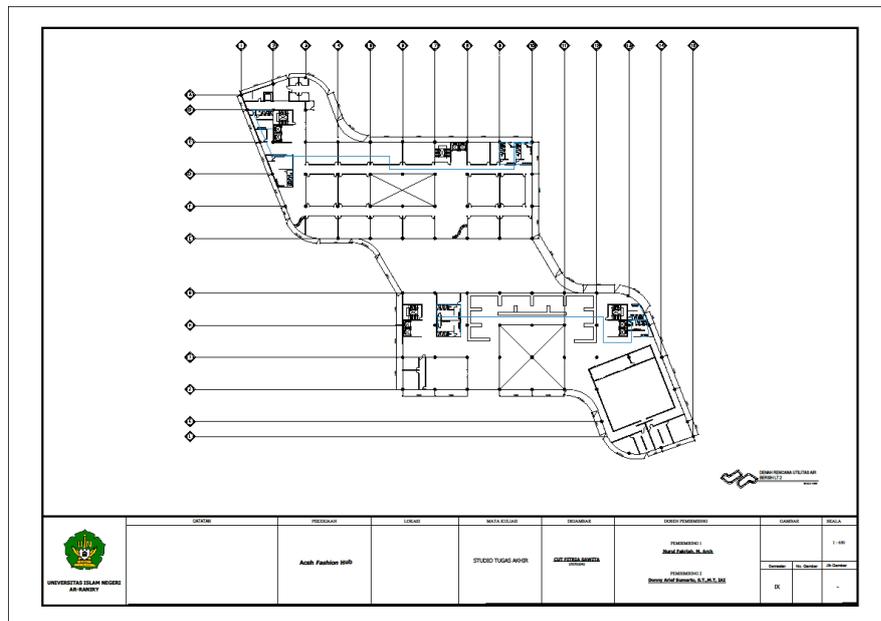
Rencana Instalasi Air Bersih Basement
